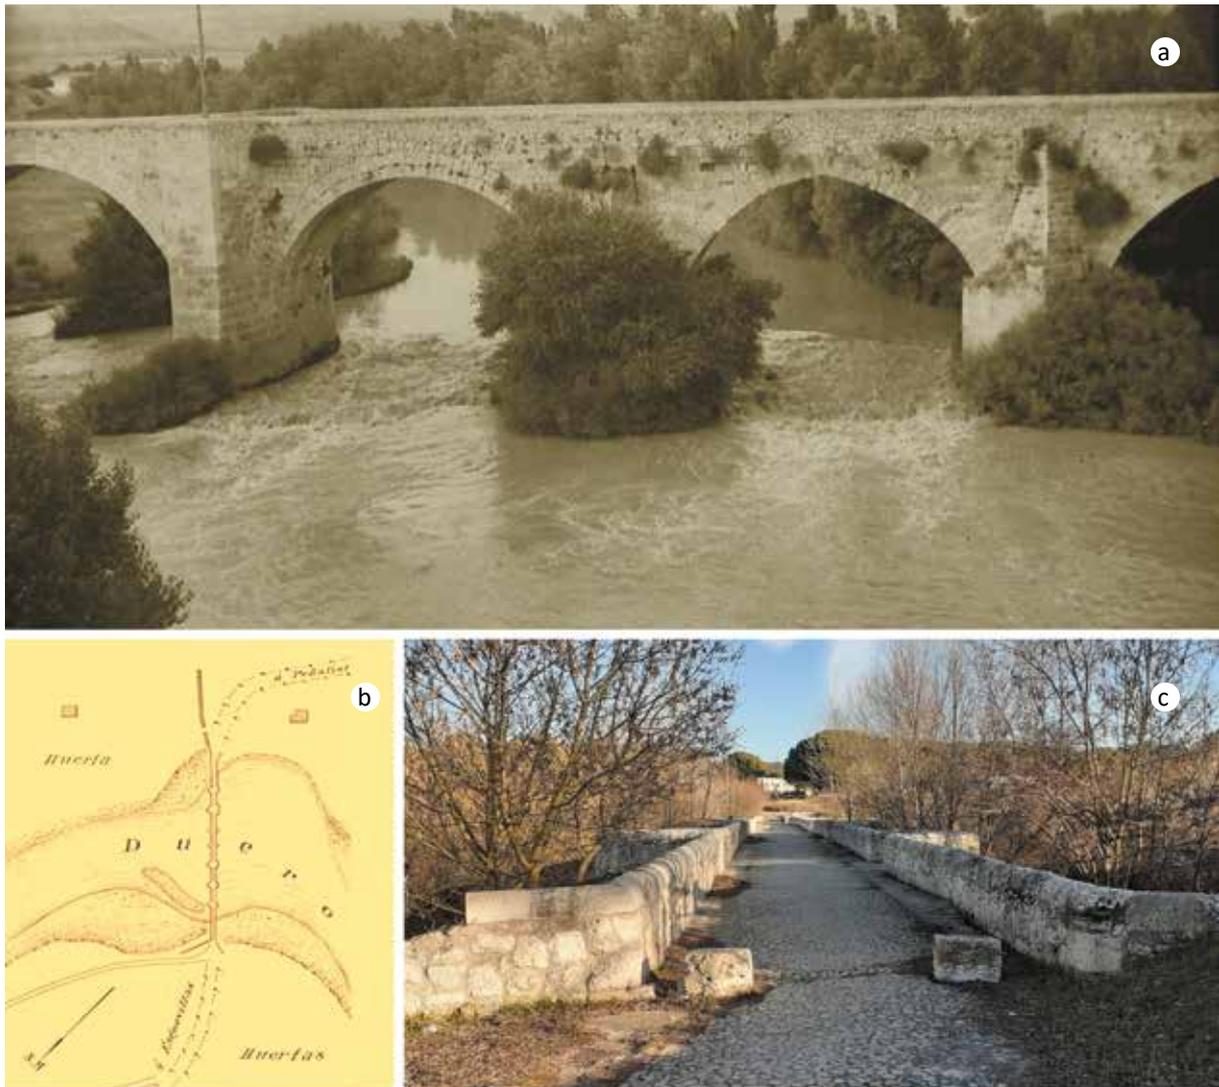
a) Vista general del puente, con los arcos 4.º y 5.º aún sin derruir, 1957 (de la colección fotográfica de Juan José Moral Daza). b) Vista general del puente. Plano del proyecto de reparación y ensanche de 1906 (Eduardo Domingo Mambrilla). c) Calzada, 2022 (fotografía del autor).
